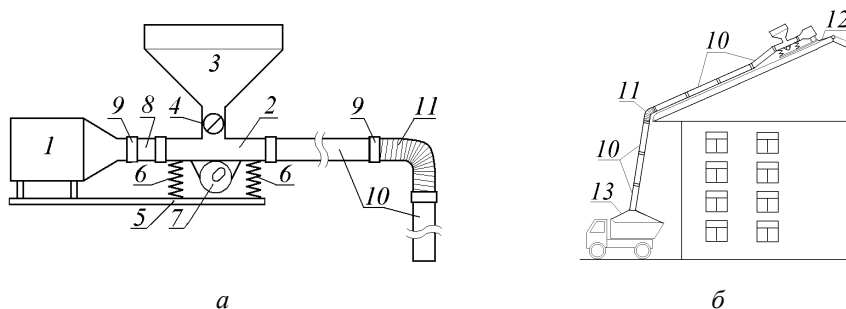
Пневмотранспортная установка для уборки снега с крыши [18]:
